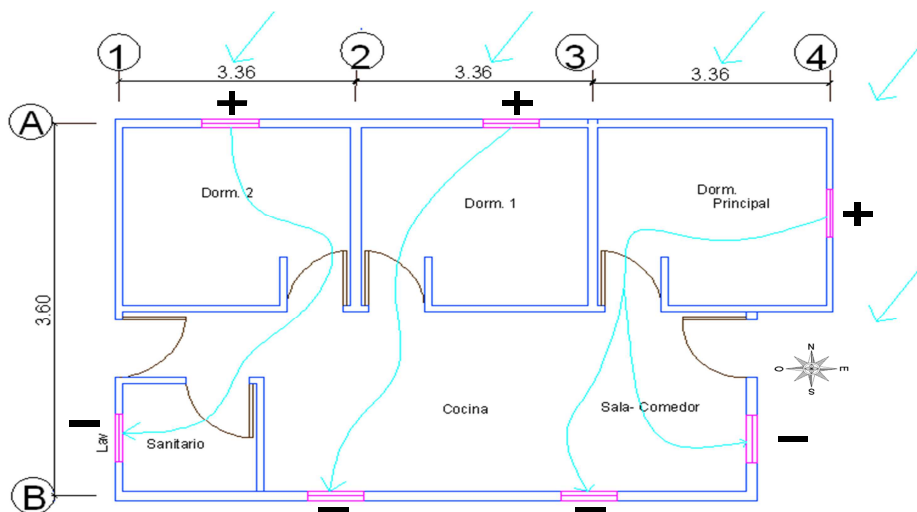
Ventilación cruzada de planta modelo 1 Corpozulia
